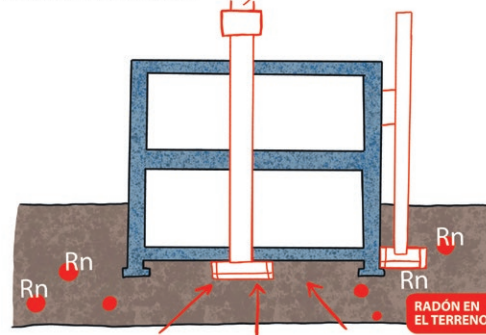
Esquema sistema compuesto de captación, conducción y extracción.
